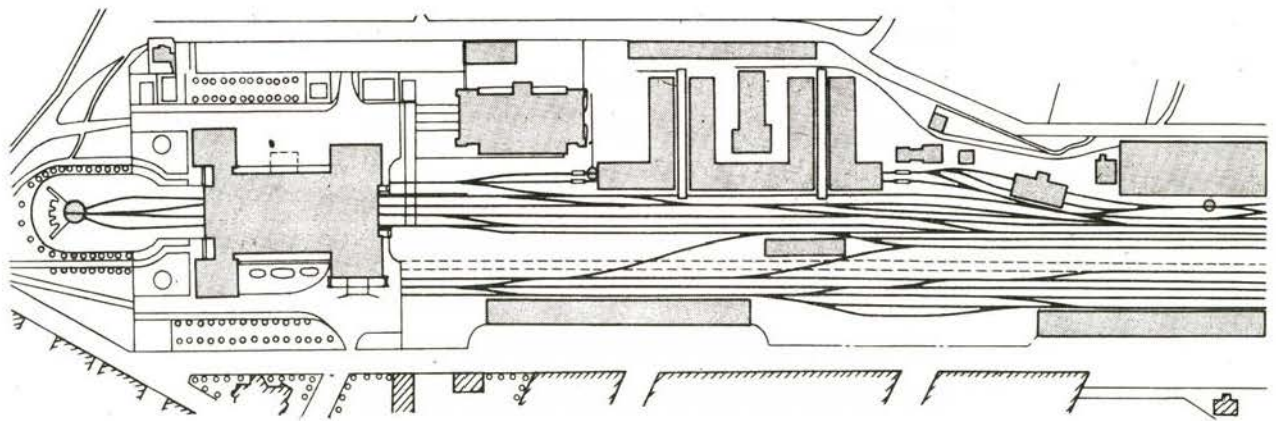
Lageplan des Bayrischen Bahnhofs um 1850; Entwurf Poetzsch
